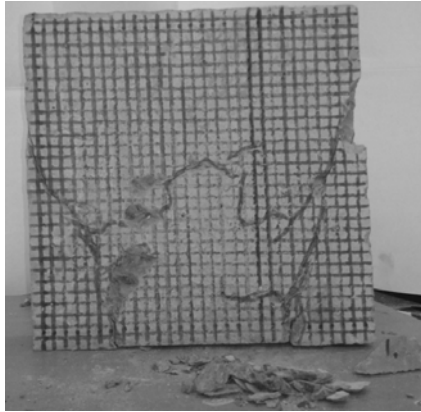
Испытание модели, армированной арматурной сеткой,
